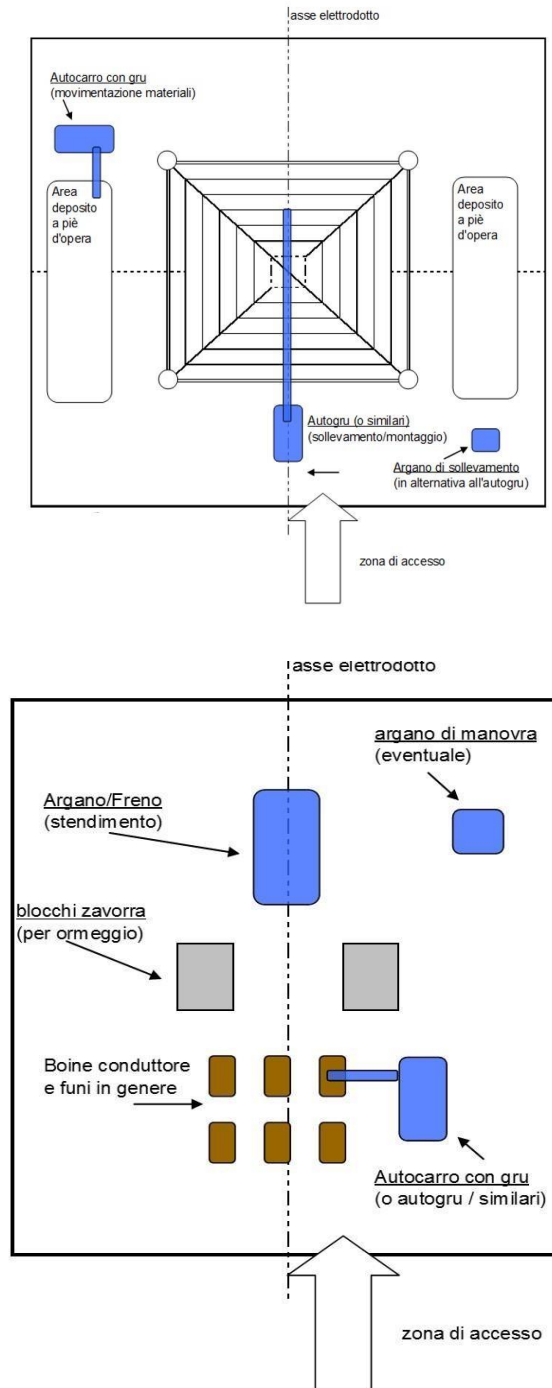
Sopra: Planimetria dell'Area Sostegno (montaggio sostegno) - Planimetria dell'Area di linea - Tipologico
